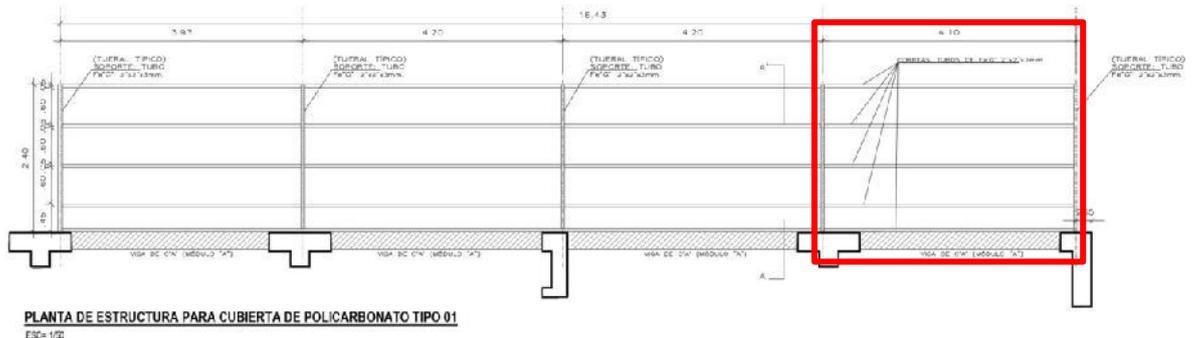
Vista en planta para cubierta de polycarbonato tipo 01 del plano D-
